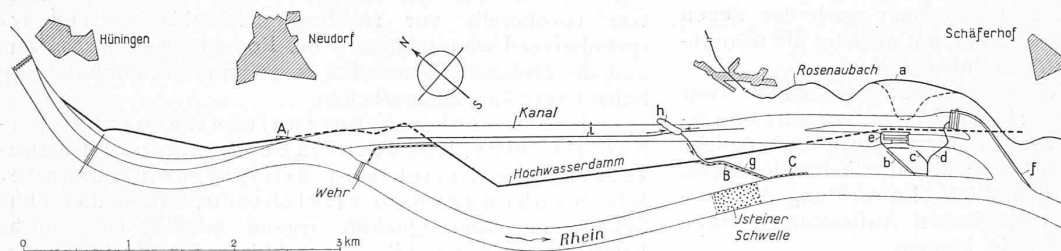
Lageplan der Baustellen mit den für die Trockenlegung der Baugruben erstellten Kanälen. — Masstab 1 : 65000
